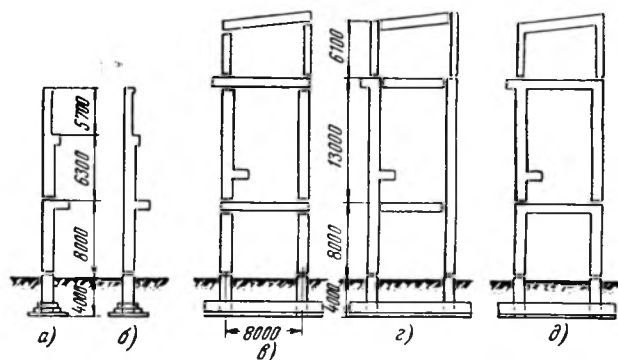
Разбивка конструкций главного корпуса на блоки несущих арматурных каркасов.
